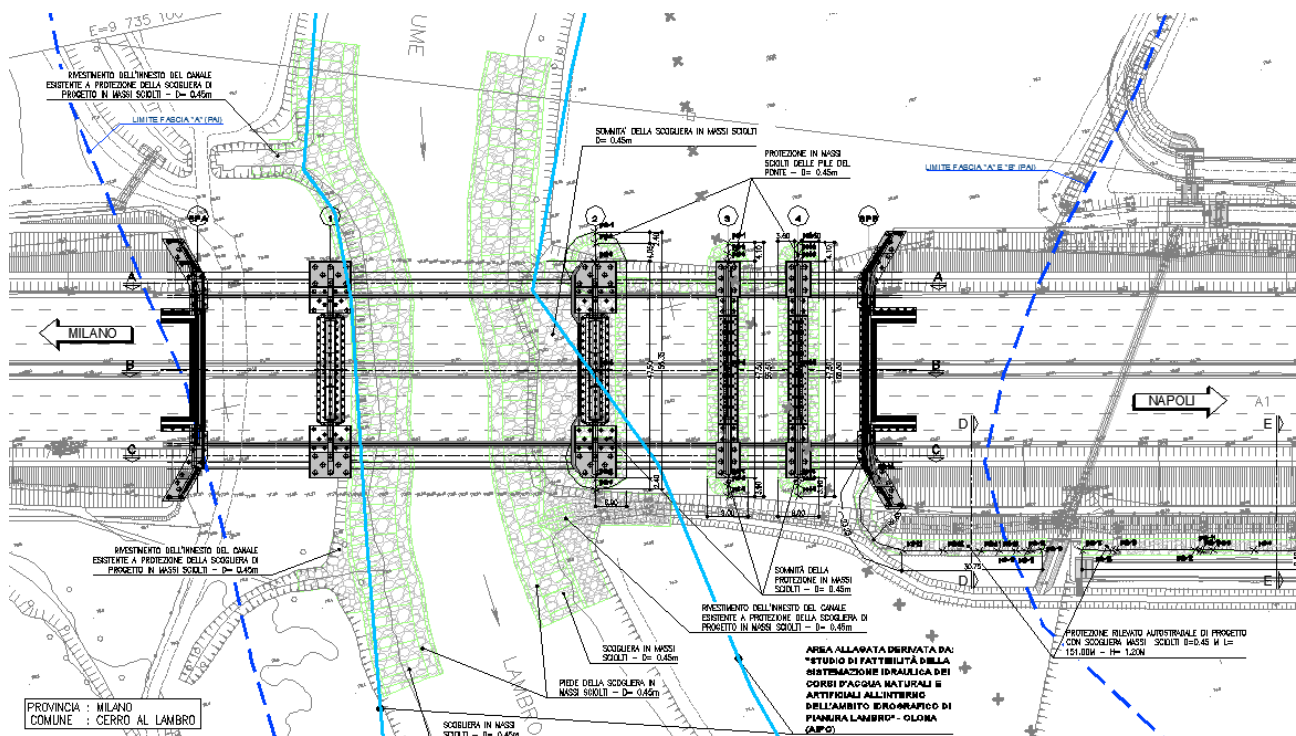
Stralcio planimetrico della sistemazione del Fiume Lambro.
